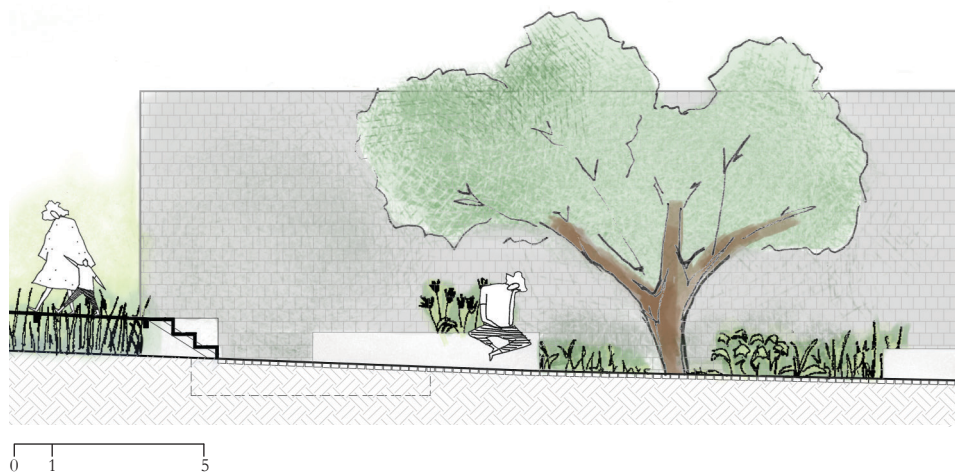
Entrada do parque. Corte longitudinal da Travessa da Fonte.
